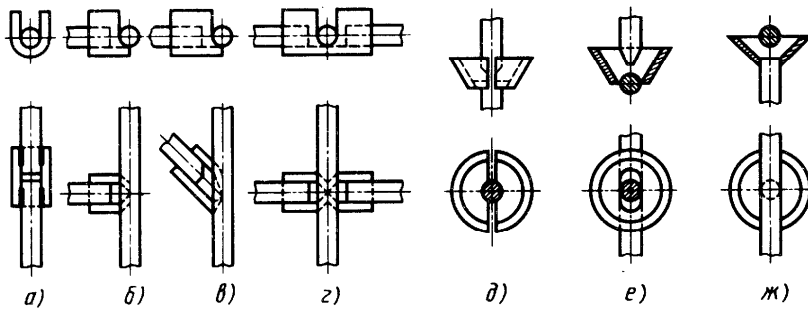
Сварные соединения арматуры, выполняемые ваннным способом
